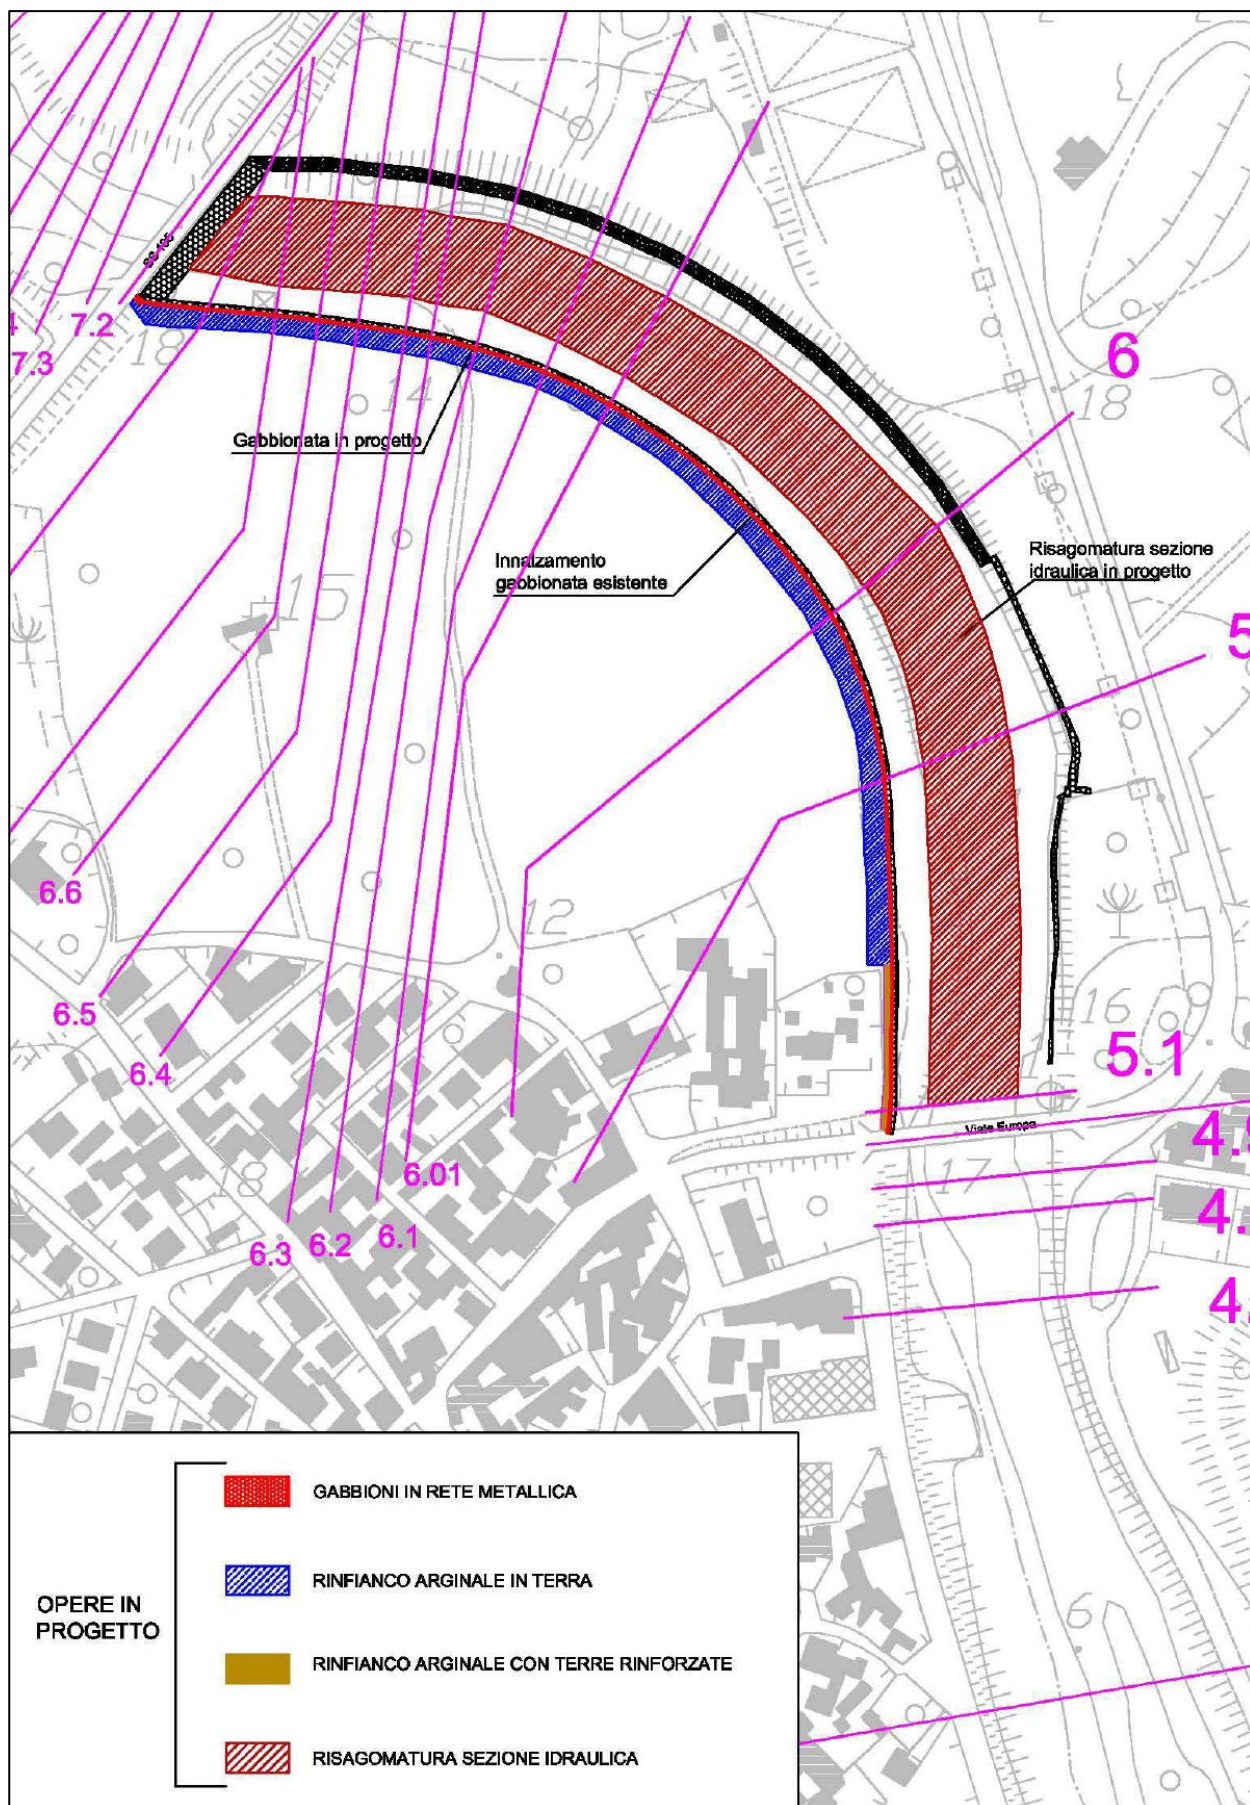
Planimetria delle aree interessate dagli interventi di sistemazione idraulica nell'ambito del progetto.
